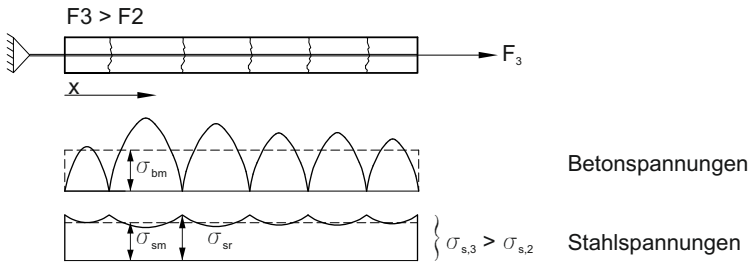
Entwicklung der Beton- und Stahlbetonspannungen in einem Stahlbetonzugstab unter steigender Belastung nach [MK95]
